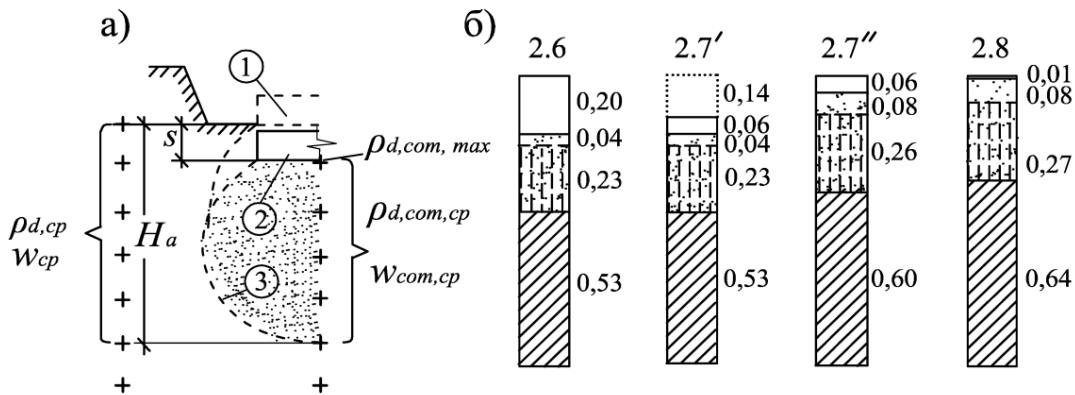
Схема поперечного перерізу основи дослідного фундаменту №2:
